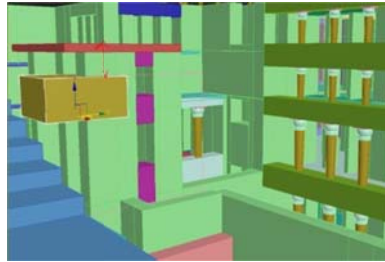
Différence de niveau par rapport au bâtiment sud en 3D
